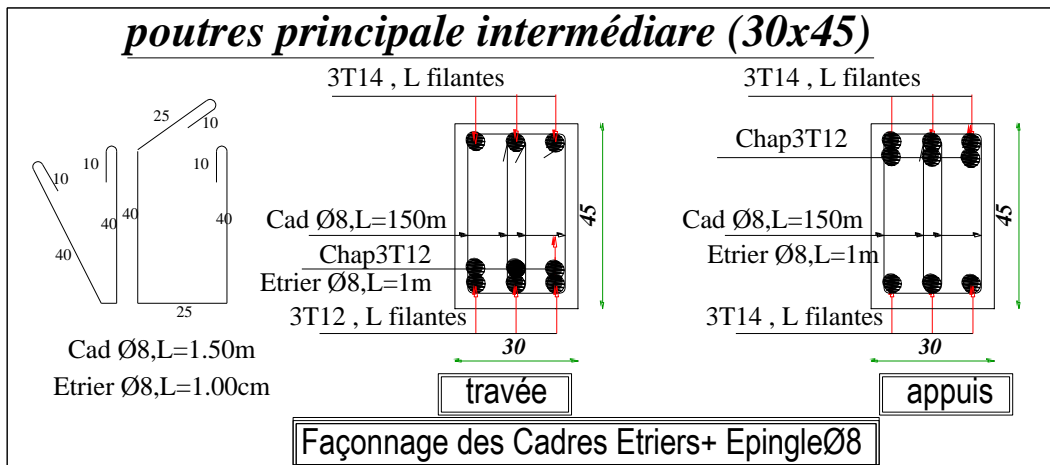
Exemple de ferrailage poutre principales intermédiaire
